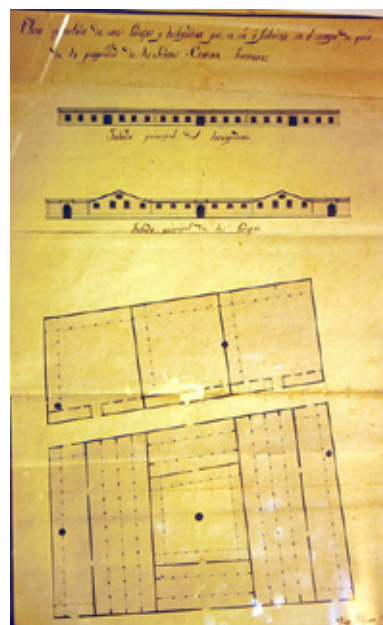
Planta y alzado de la Bodega de Carlos Carrera. AMEPSM.
